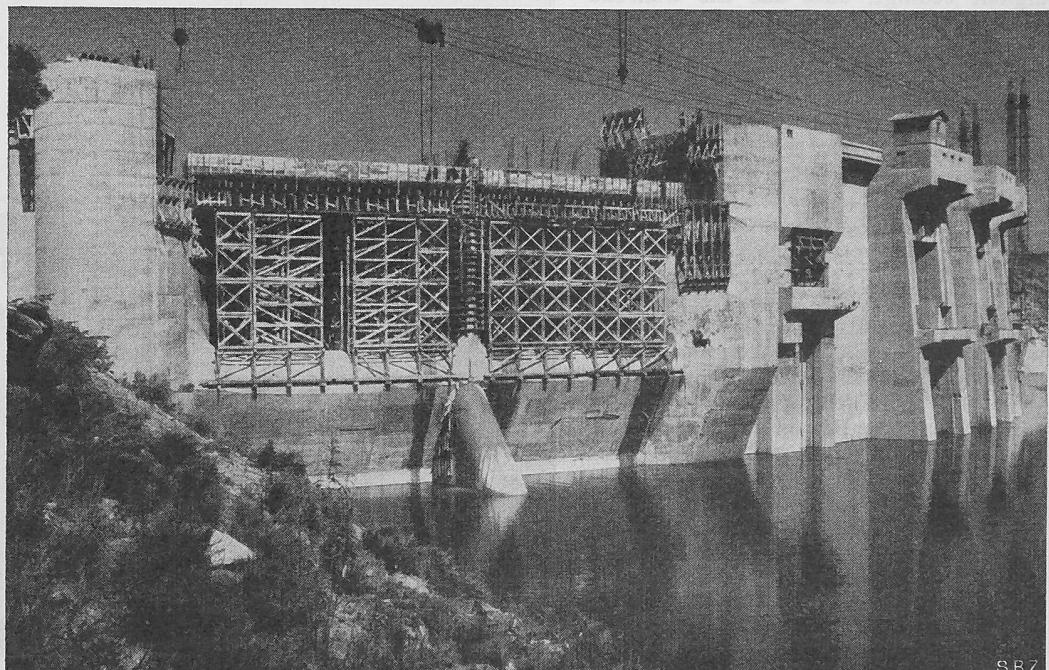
Schalung der Einlauf-Decke; rechts Grundablass und Wasserfassungen. 4. Aug. 1950
